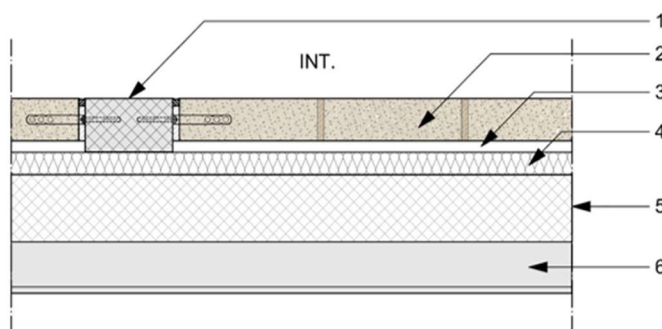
Cas B – Schéma de principe avec poteau d'ossature secondaire en maintien du parement
